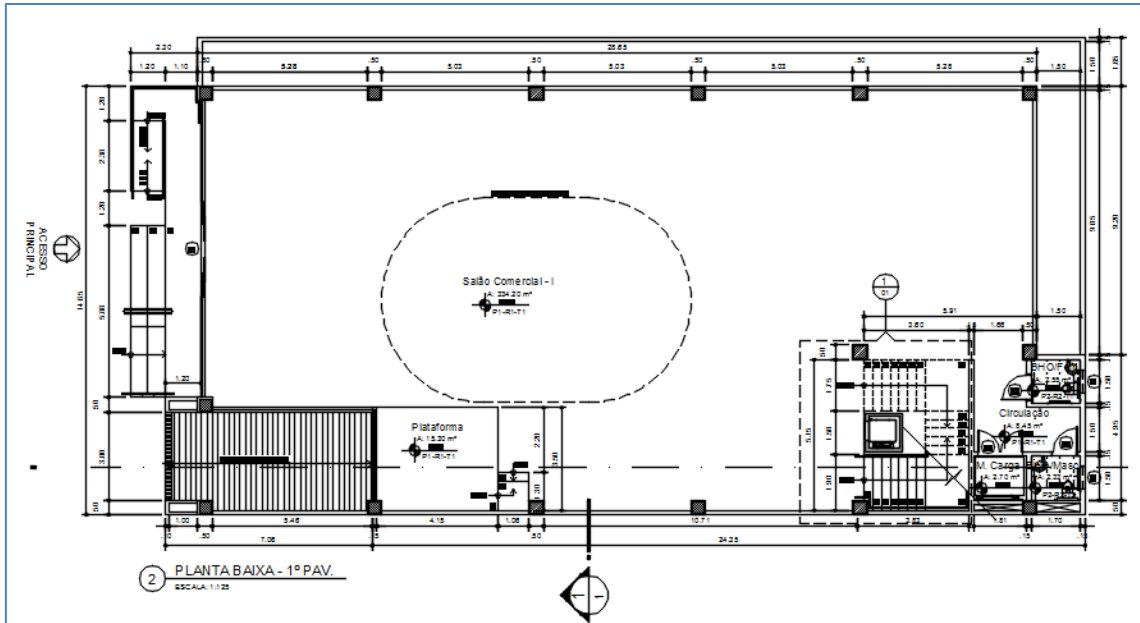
Planta baixa: 1º pavimento (autor do projeto arquitetônico)
